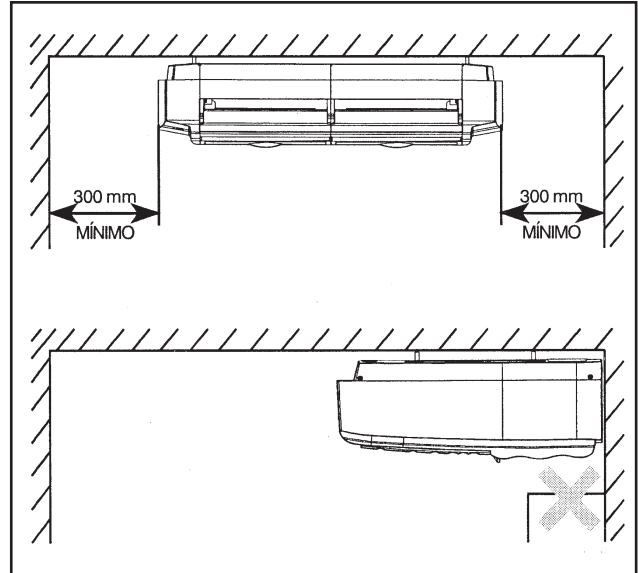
MONTAGEM TETO - UNDER CEILING
